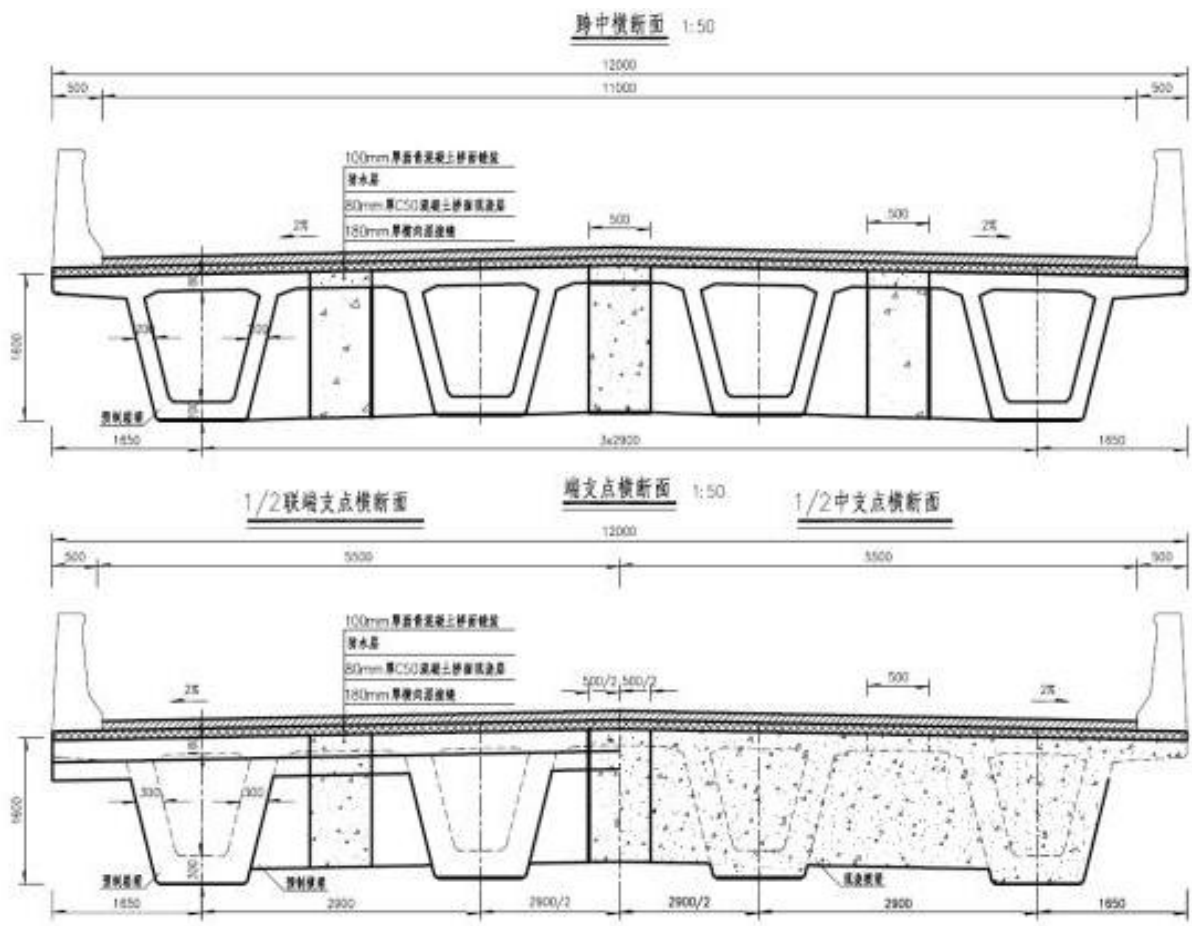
12m 宽 30m 跨径预制混凝土箱梁标准横断面图
